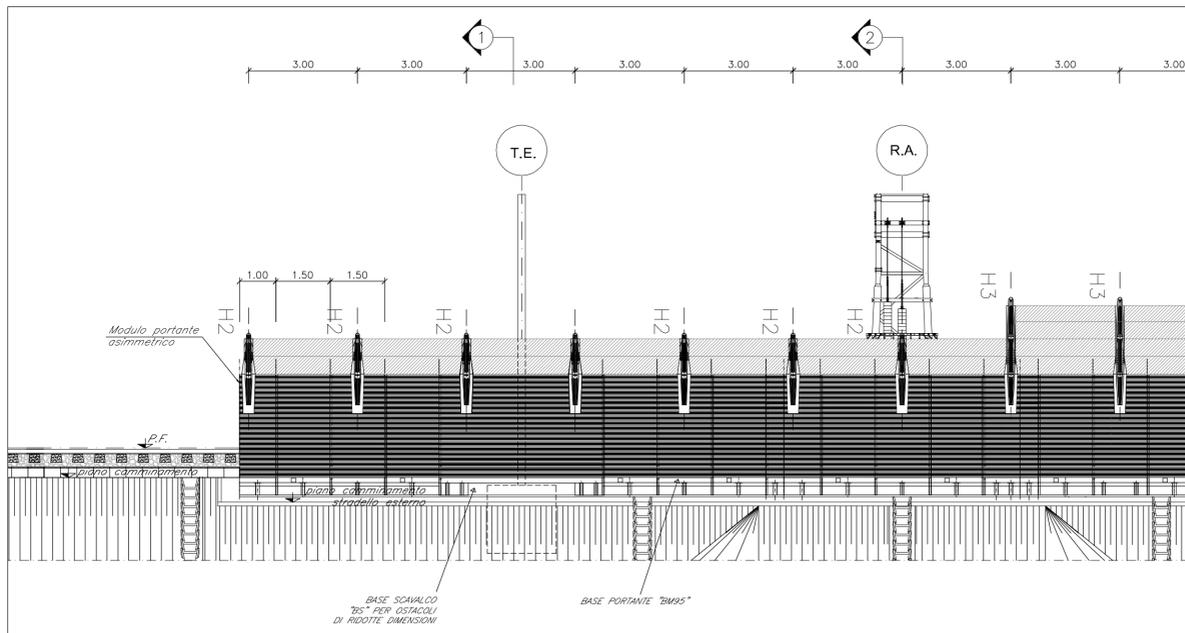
Stralcio del prospetto delle barriere fonoassorbenti
